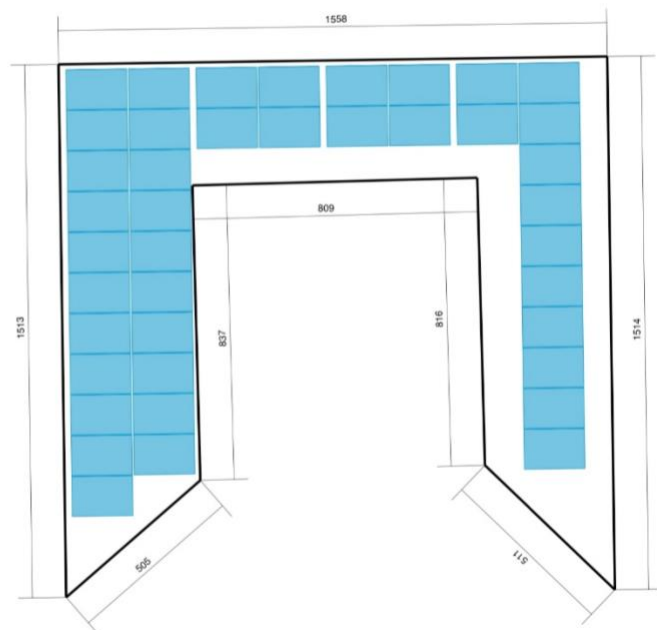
Zürcherstrasse 90.1, Belegungsplan, Dachfläche 2
